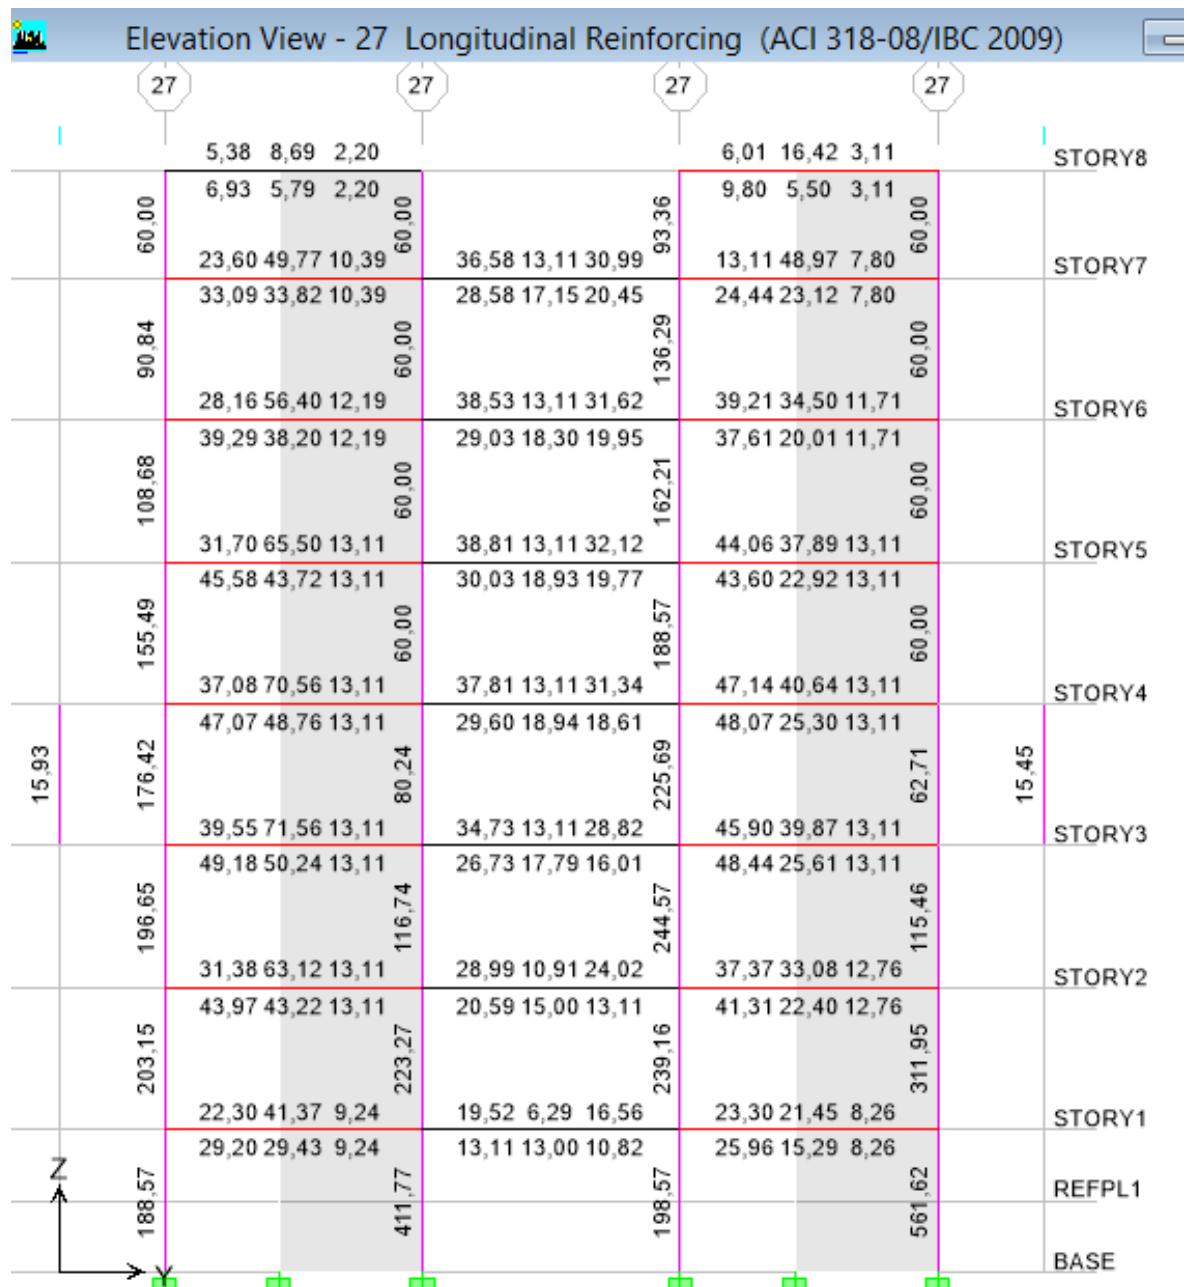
Acero en Vigas y Columnas en el Pórtico 27 – Hospitalización 2- (NEC-11)
